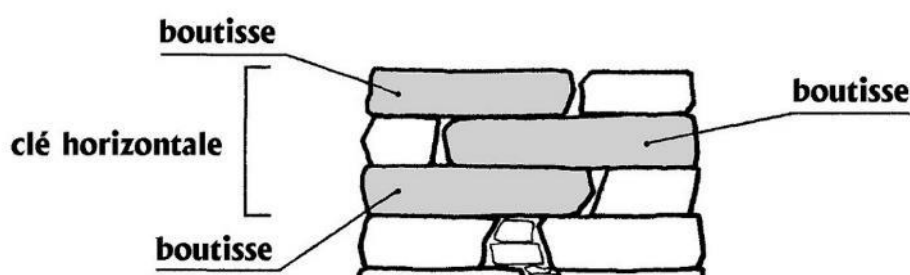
Exemple de boutisse permettant de renforcer la structure du mur
